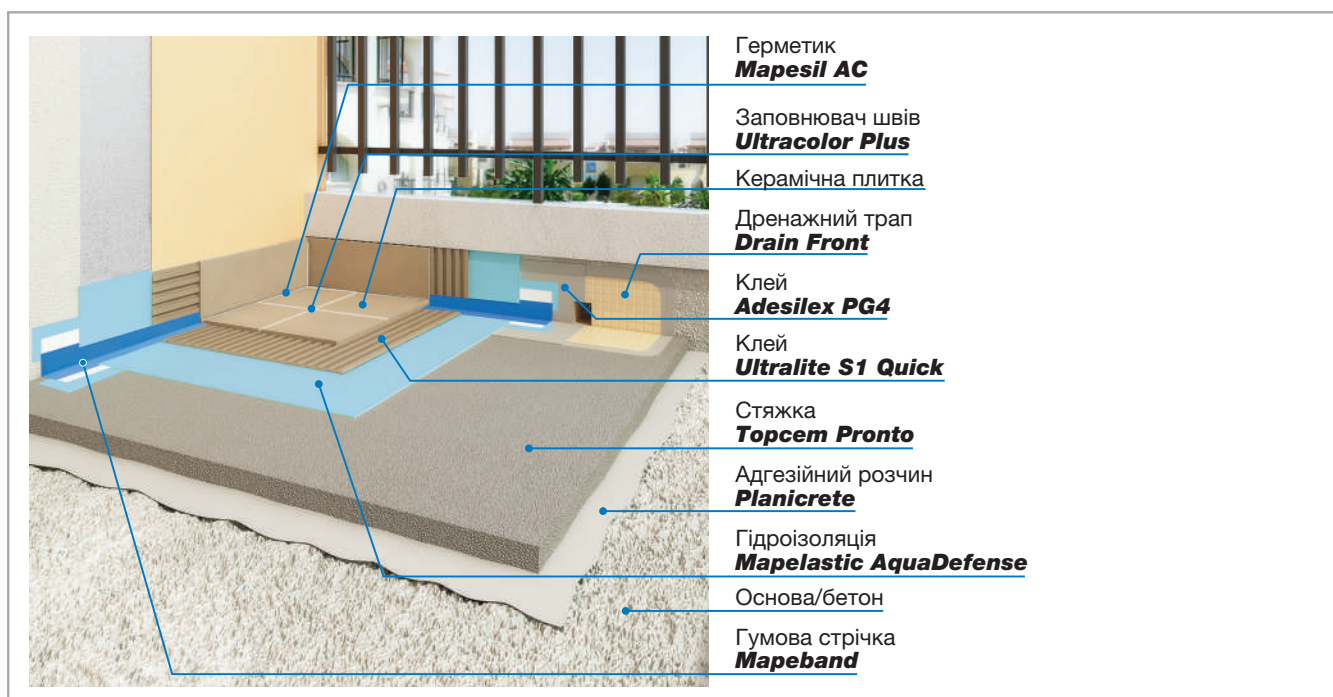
Адгезійна стяжка з клеючим розчином на основі PLANICRETE
